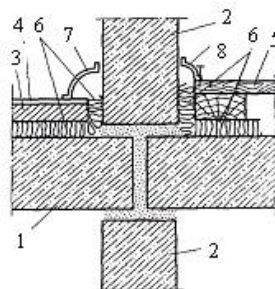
Примыкание пола на звукоизоляционной прослойке к стене:
